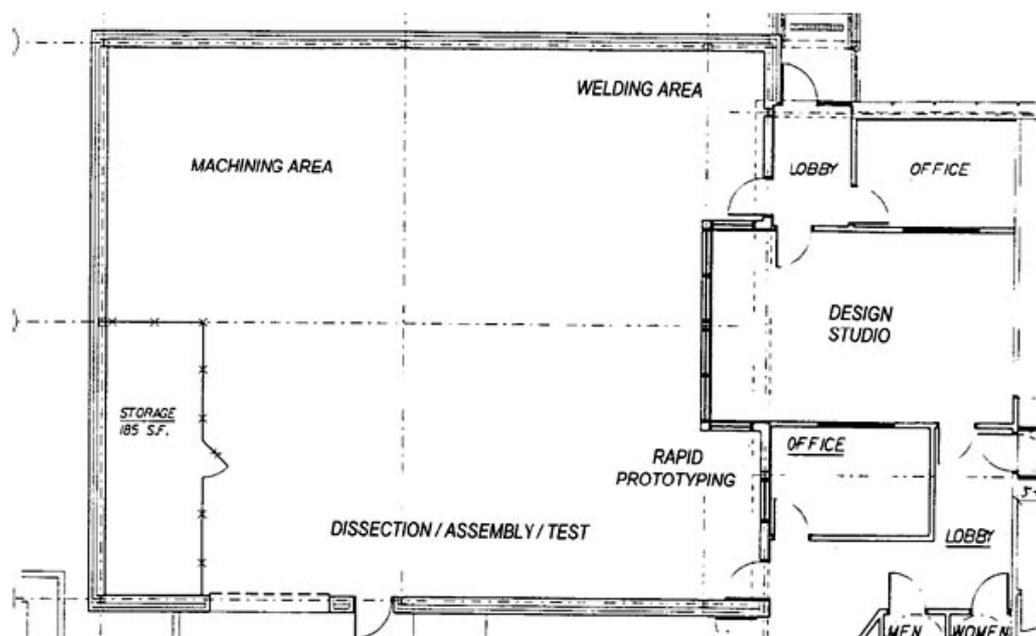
Plano distribución planta Pennsylvania University (Hadlock H, 2008).
